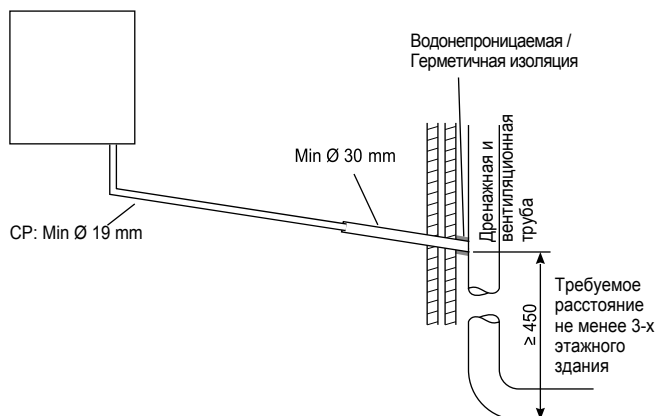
Подсоединение слива конденсата к дренажной и вентиляционной трубе
